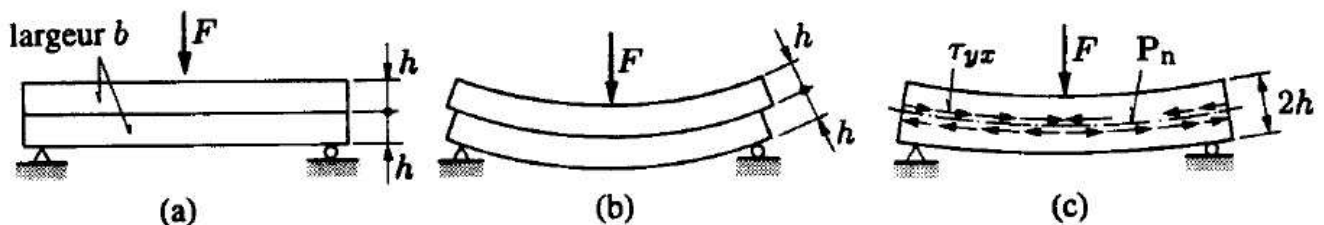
Etat de contraintes sans connecteur et avec connecteur dans une poutre mixte en bois-béton [4]
